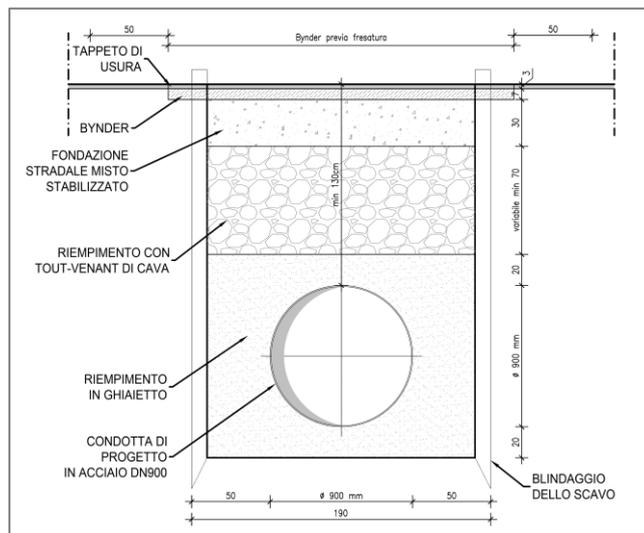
Sezione tipo di posa su strada statale/provinciale - stralcio 1.
